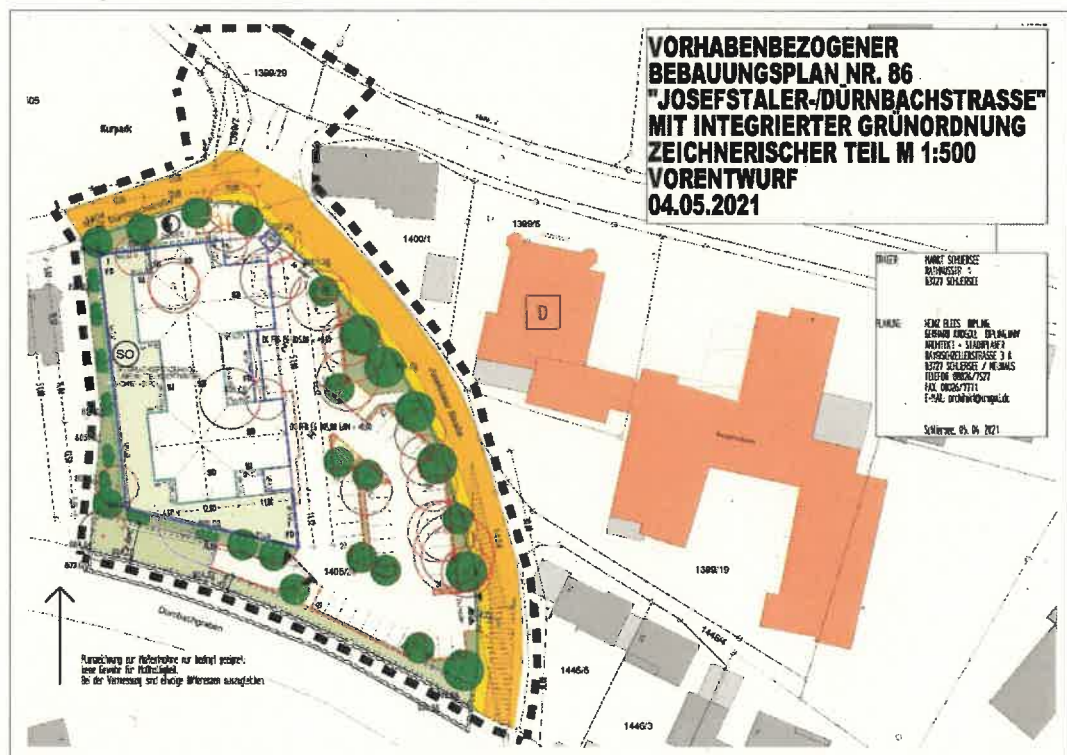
Planentwurf Bebauungsplan Nr. 86 der Gemeinde Schliersee, Stand: 04.05.2021.
